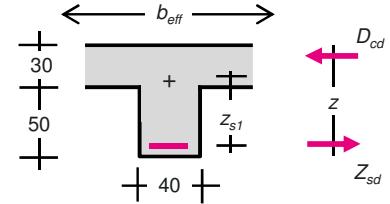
Bewehrungskonstruktion: Querschnitt
